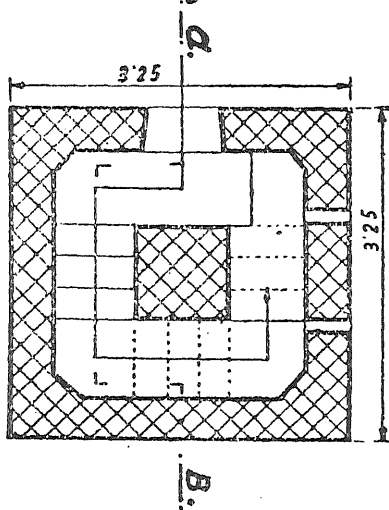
BOLLULLOS DE LA MITACIÓN (SEVILLA). ERMITA DE CUATROHABITAN. PLANTA BAJA DEL ALMINAR.
